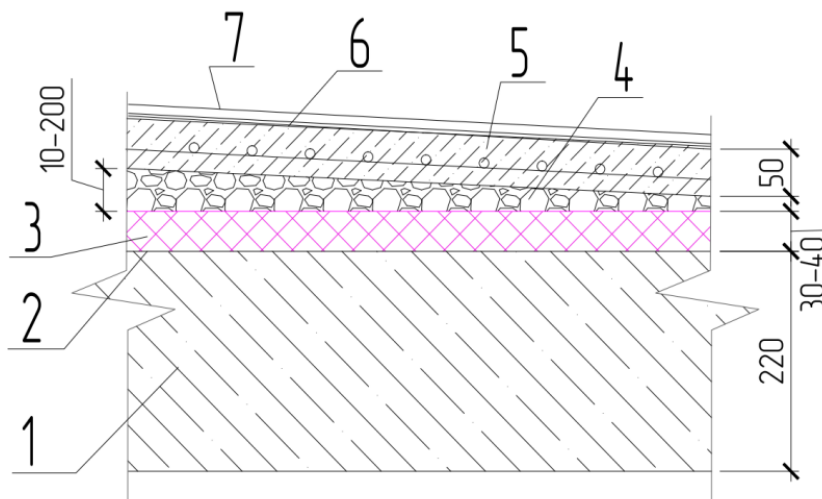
Конструкция покрытия с использованием вакуумного утеплителя: 1 – железобетонная плита покрытия 220мм, 2 – унифлекс ТПП, 1 слой, 3 – вакуумная панель 30 мм, 4 – керамзитобетонный гравий 10 – 200 мм, 5 – армированная ц/п стяжка – 50 мм, 6 – праймер битумный, 7 – техноэласт.
